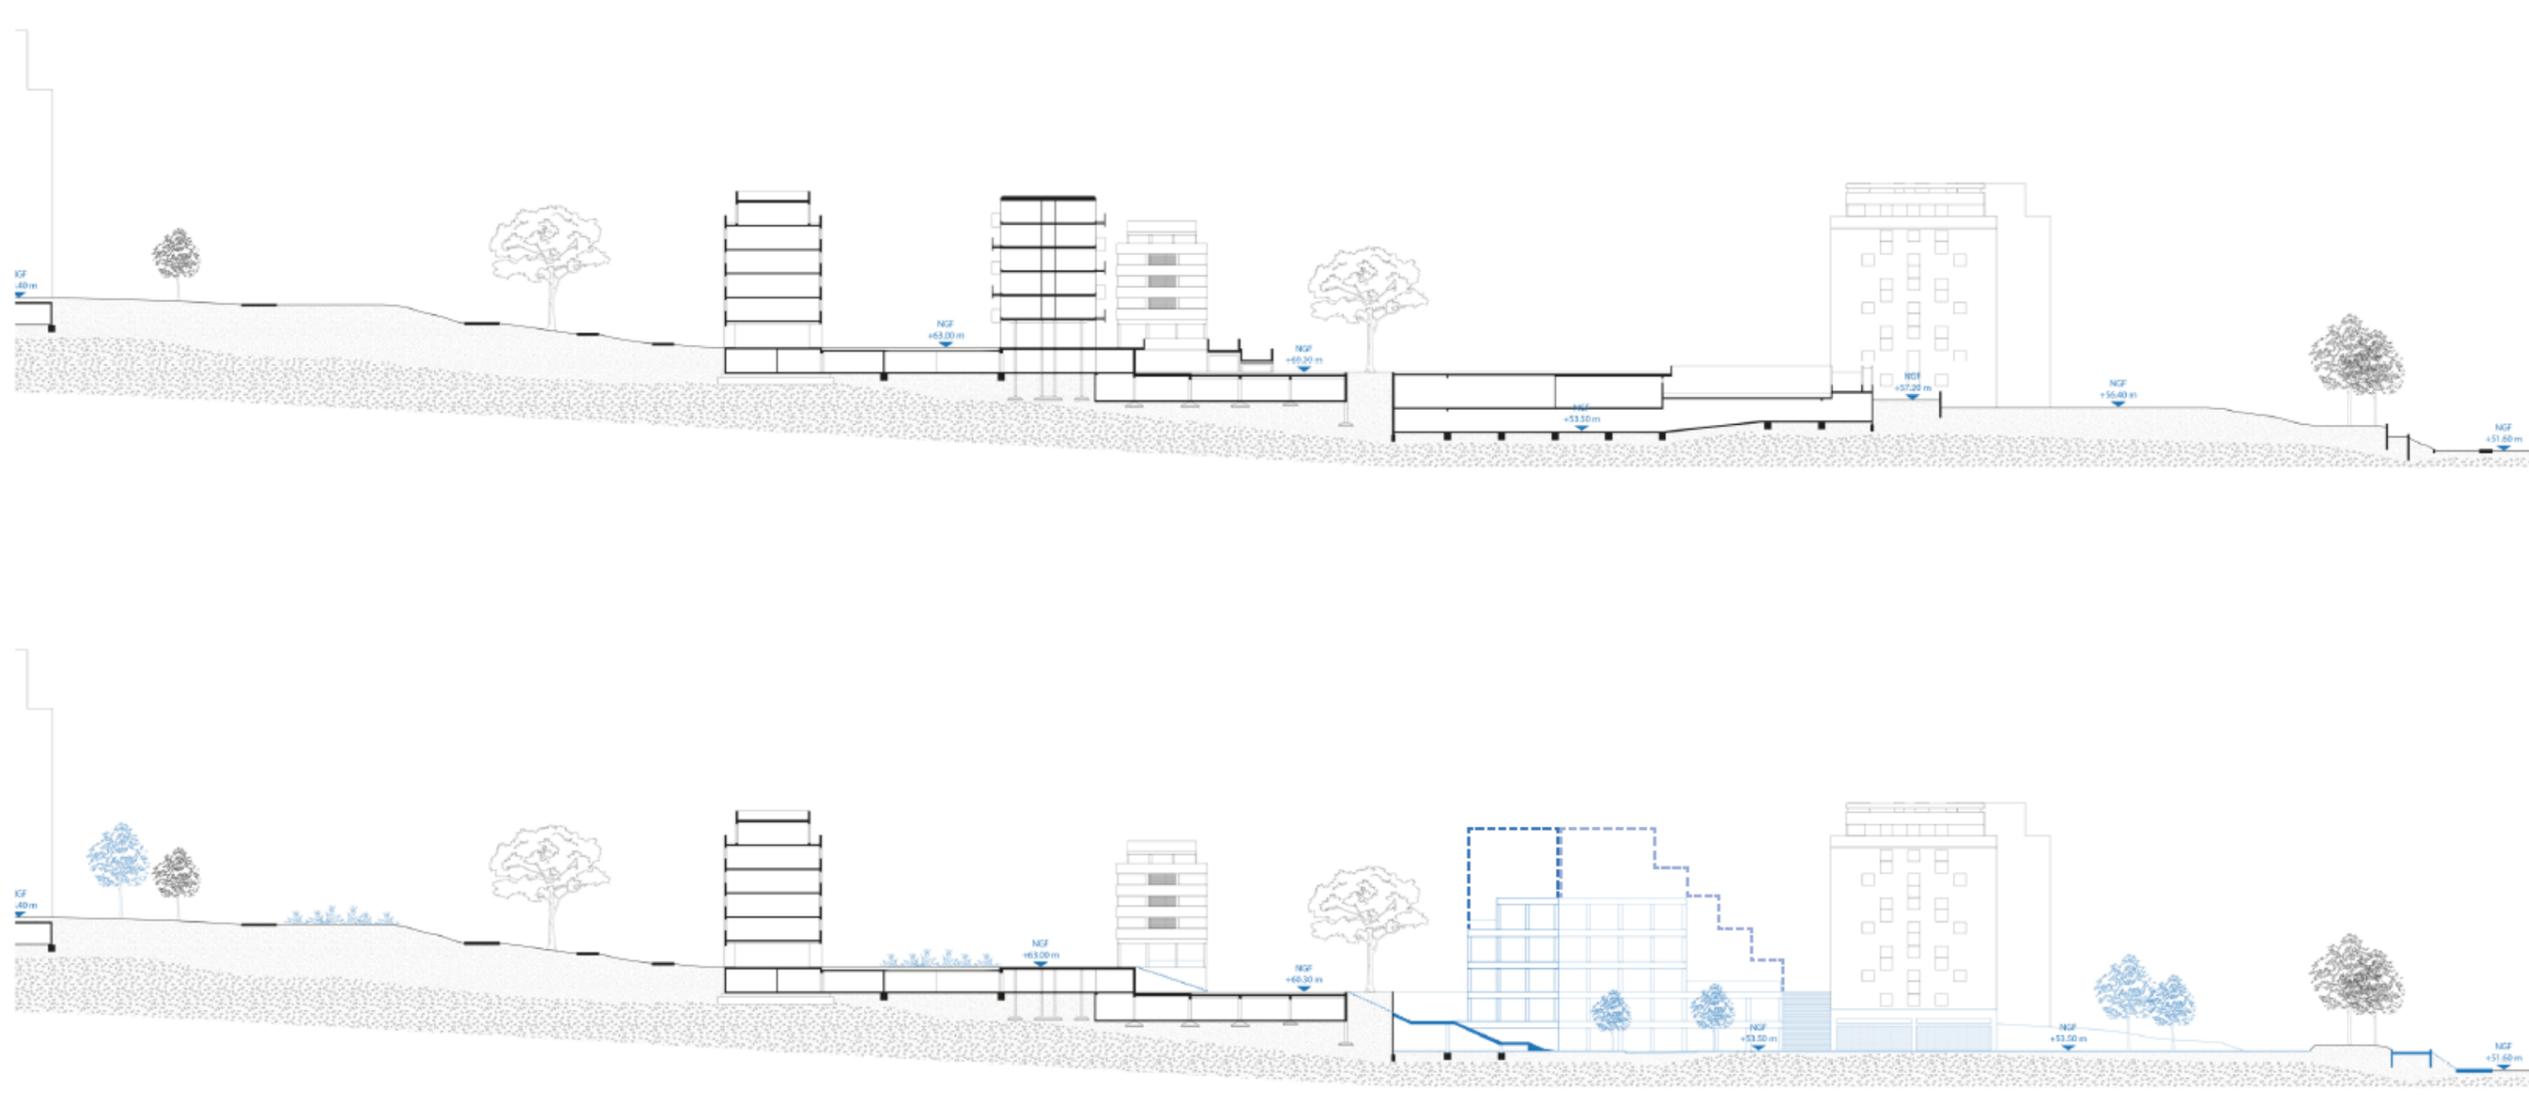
Coupe Est-Ouest sur le bâtiment en Equerre
